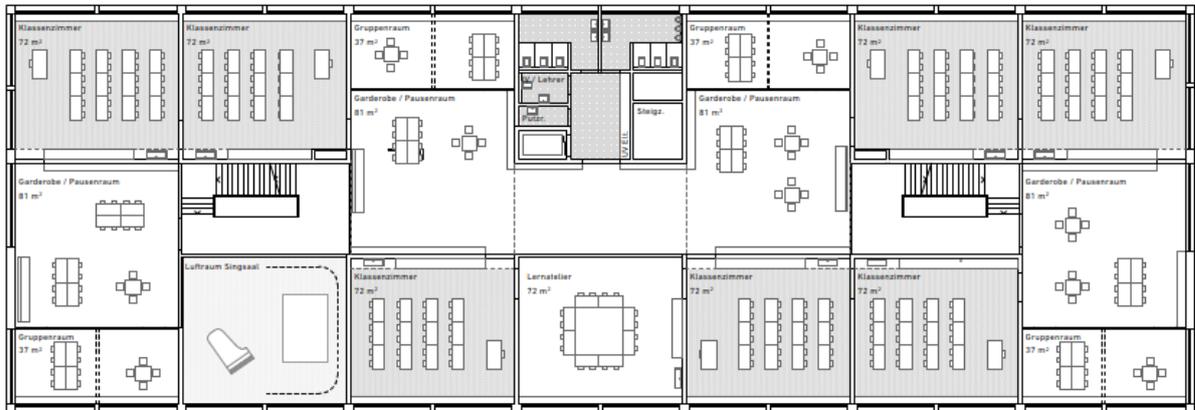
Grundriss 2. Obergeschoss
